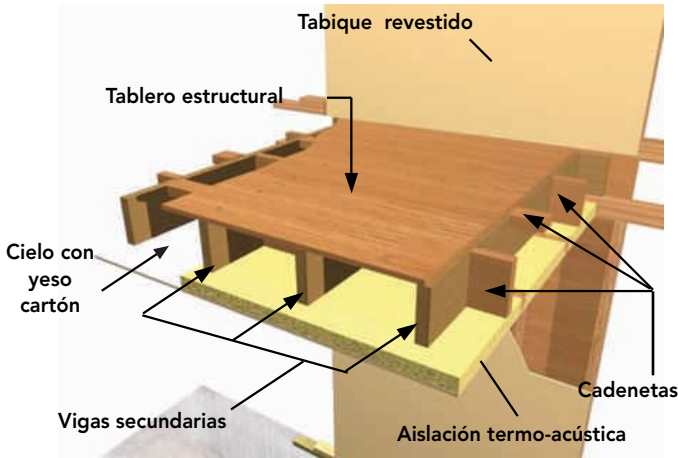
Elementos de la plataforma de entrapiso y disposición del tablero estructural.
